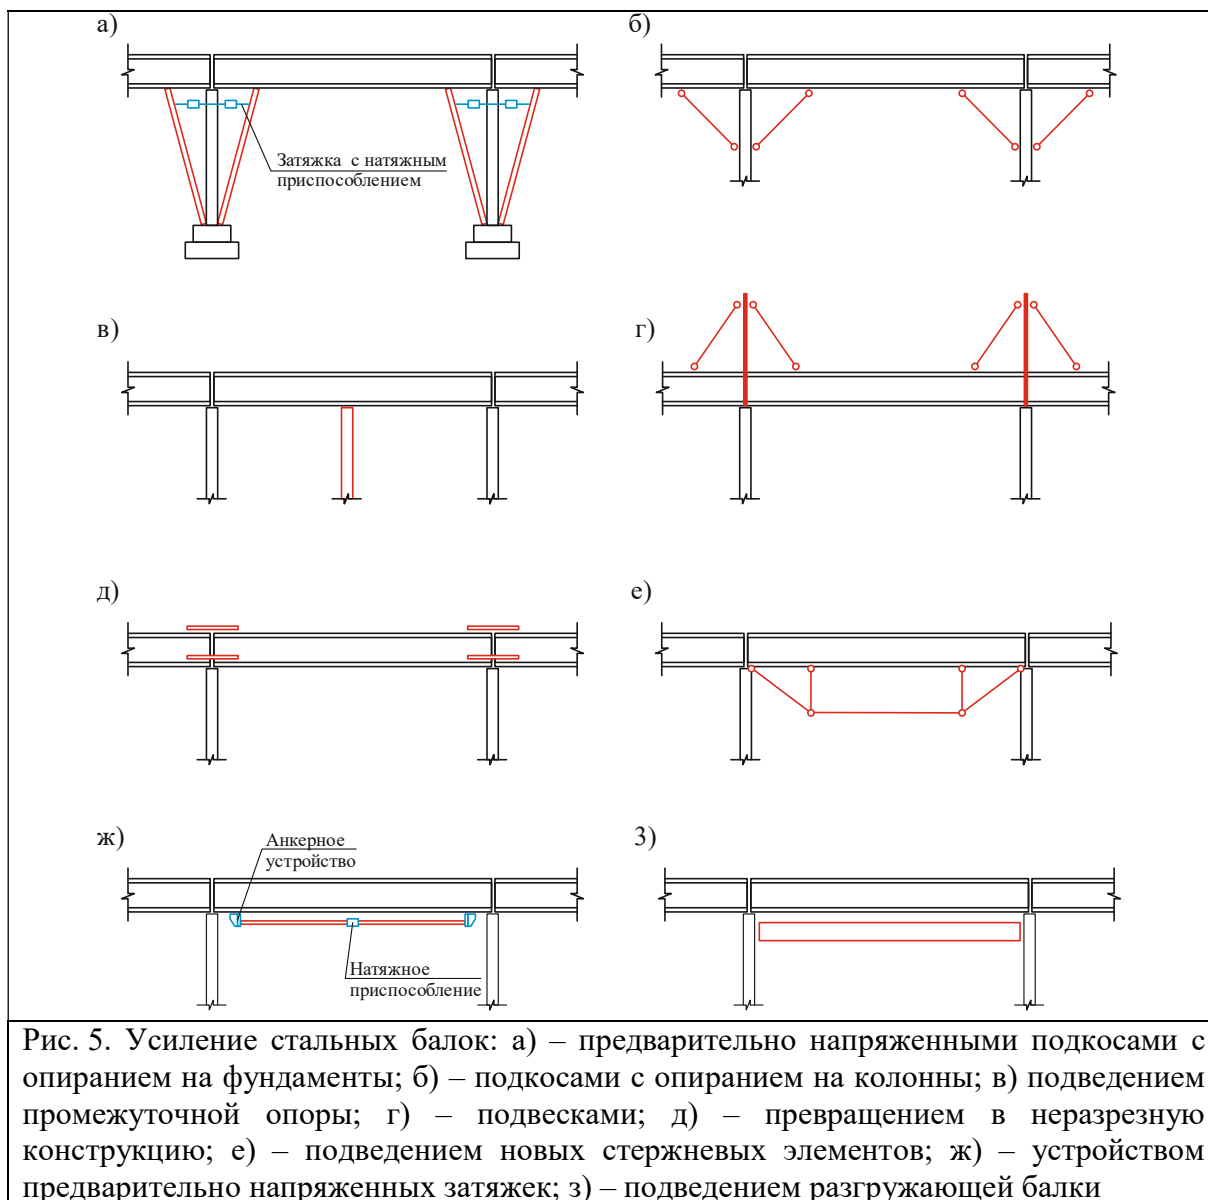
Усиление стальных балок: а) – предварительно напряженными подкосами с опиранием на фундаменты; б) – подкосами с опиранием на колонны; в) подведением промежуточной опоры; г) – подвесками; д) – превращением в неразрезную конструкцию; е) – подведением новых стержневых элементов; ж) – устройством предварительно напряженных затяжек; з) – подведением разгружающей балки
